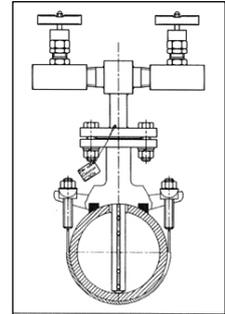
Universal-Anbohrschelle mit Flanschabgang DN40/PN4 (Gas) / PN16 (Wasser)
